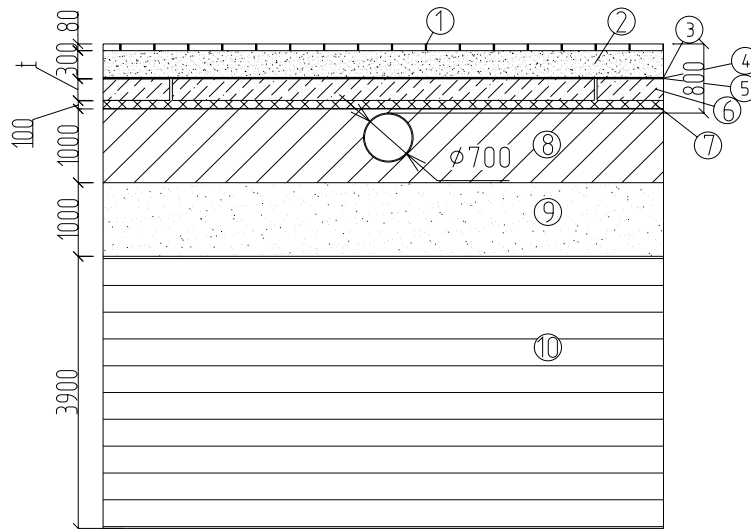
Рассматриваемая конструкция пола каре: 1 – тротуарная плитка; 2 – песчаная отсыпка; 3 и 5 – геотекстиль; 4 – бентонитовые маты; 6 – бетонное основание; 7 – теплоизоляционный слой; 8 – сугесь; 9 – песок; 10 – водонасыщенная глина.
